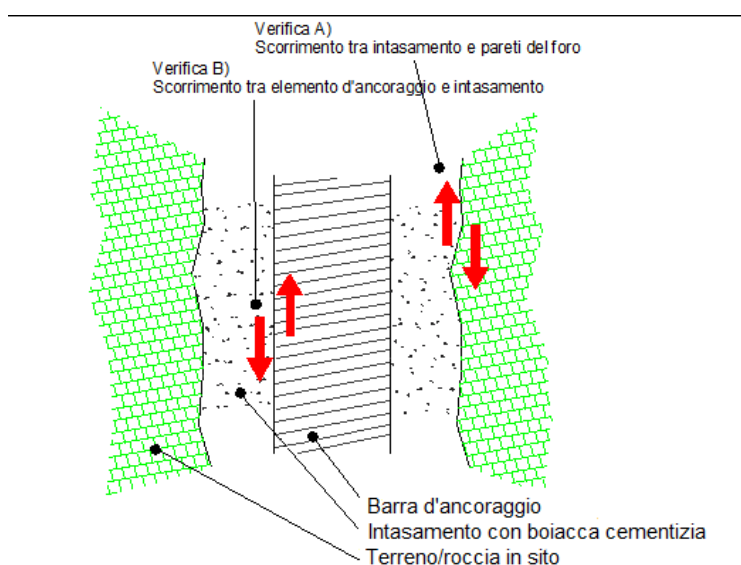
Verifiche rispetto allo sfilamento dell'ancoraggio.
